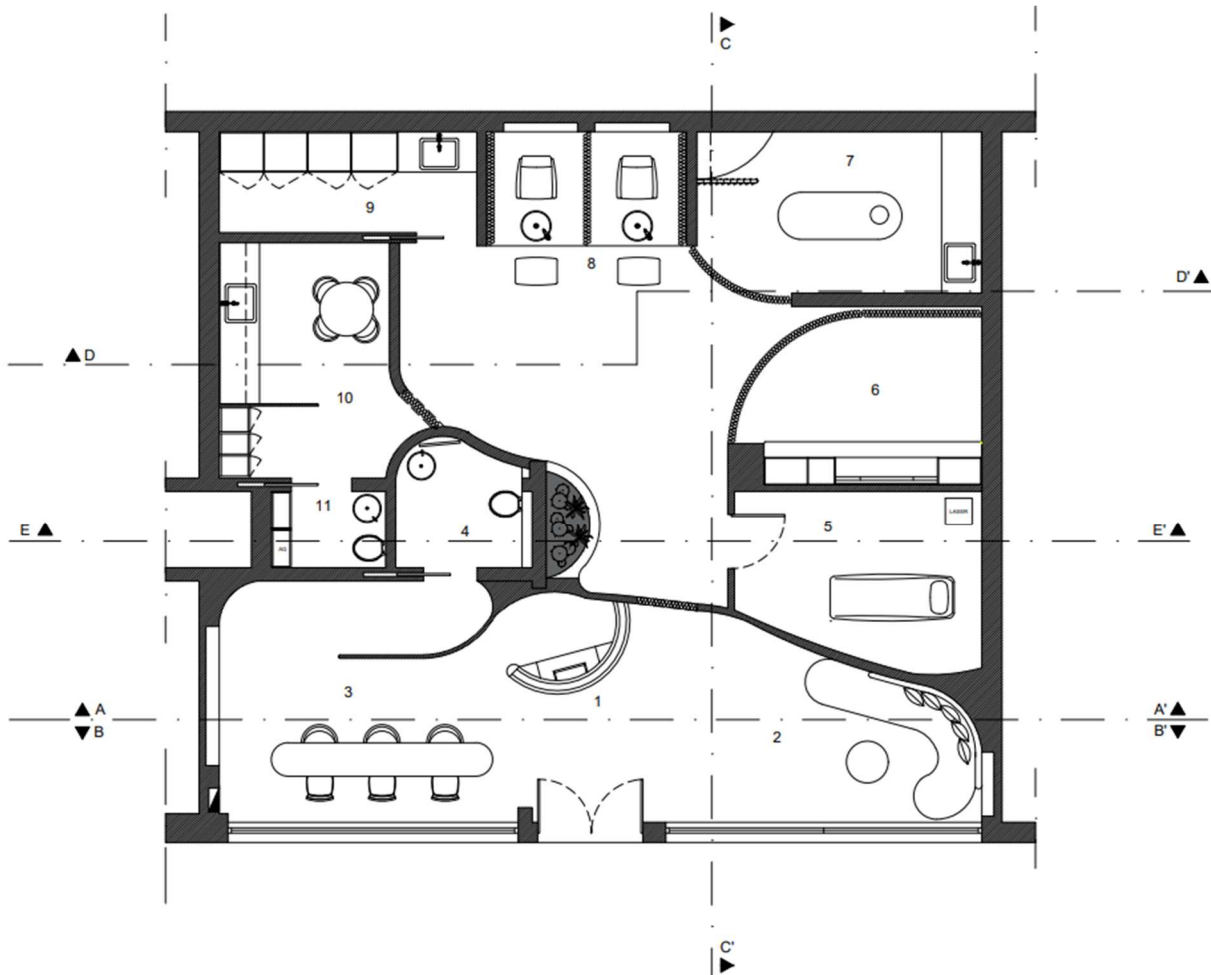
Planta de Alterações s/ escala; Fonte: Autor
